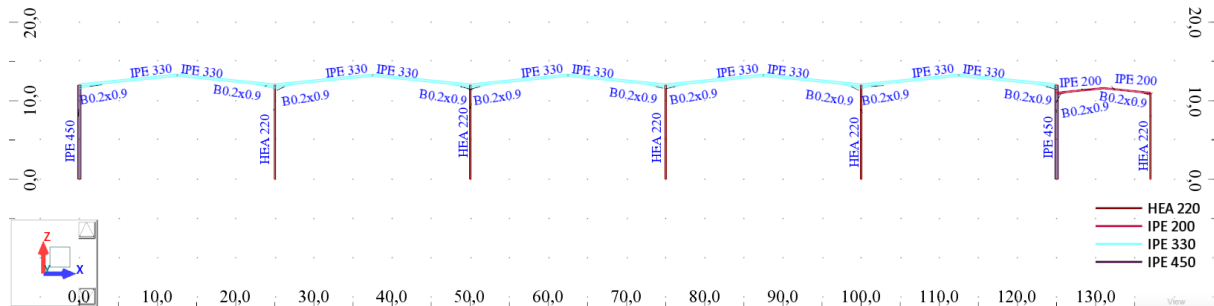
E1 - S1 – pórtico com pilares rotulados
